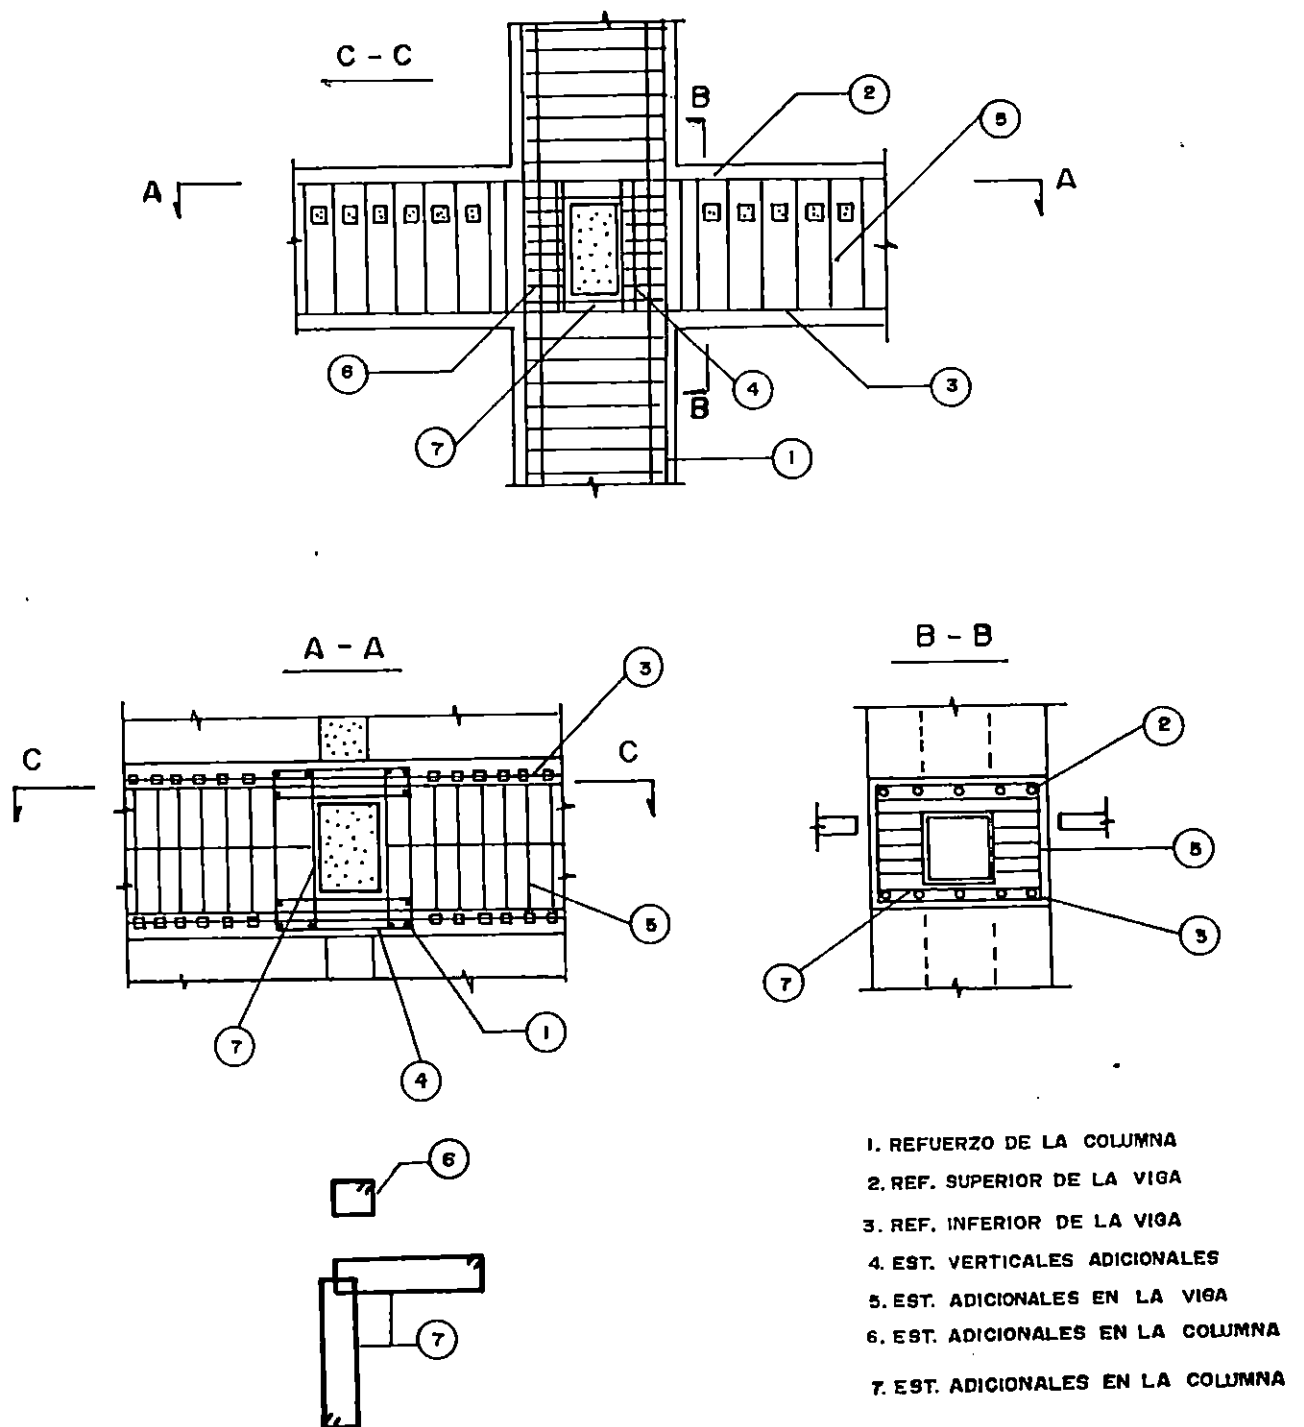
ENCAMISADO DE NUDOS CON CONCRETO REFORZADO
